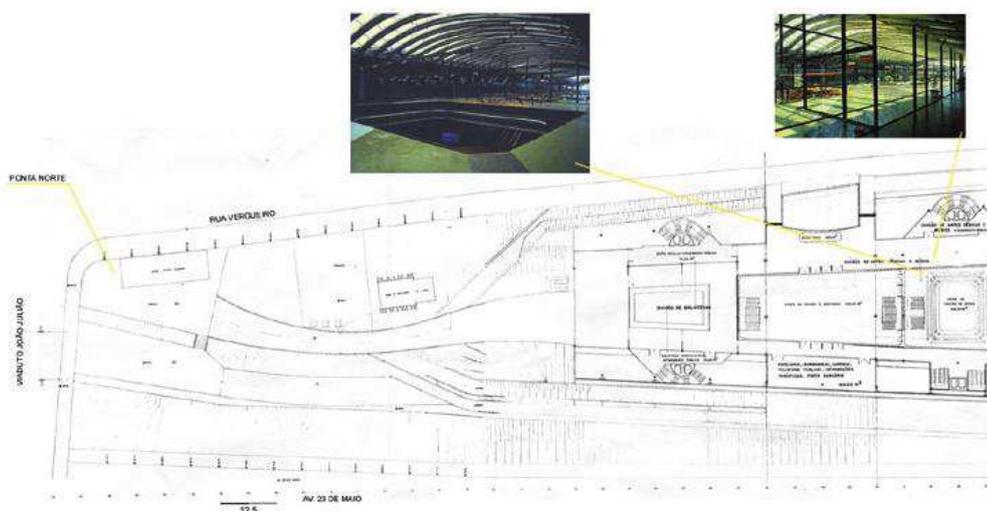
Planta baixa do Centro Cultural São Paulo – ponta norte
